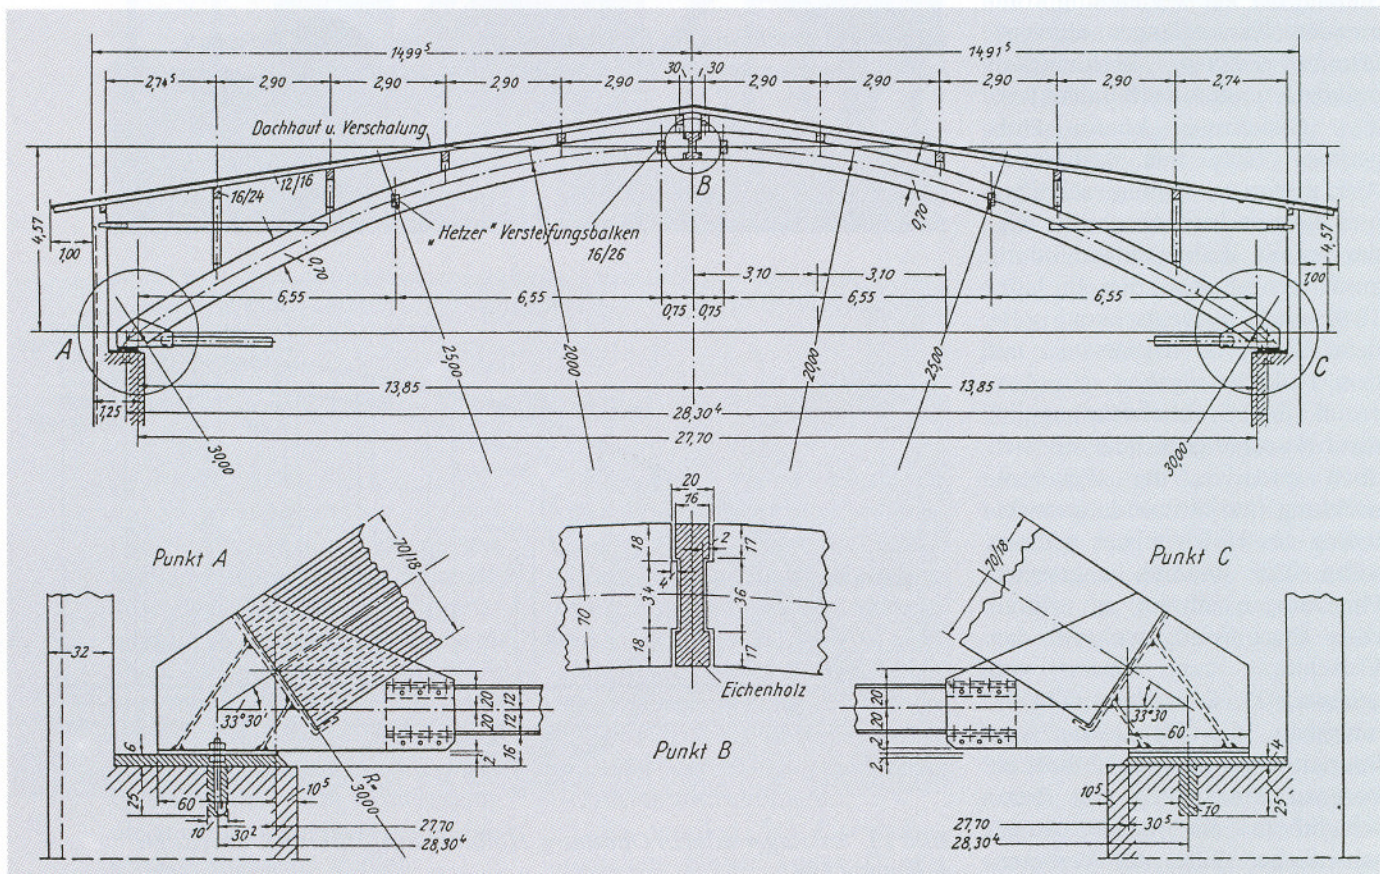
Brettschicht-Bogenbinderkonstruktion einer Lagerhalle in Biel/Schweiz
